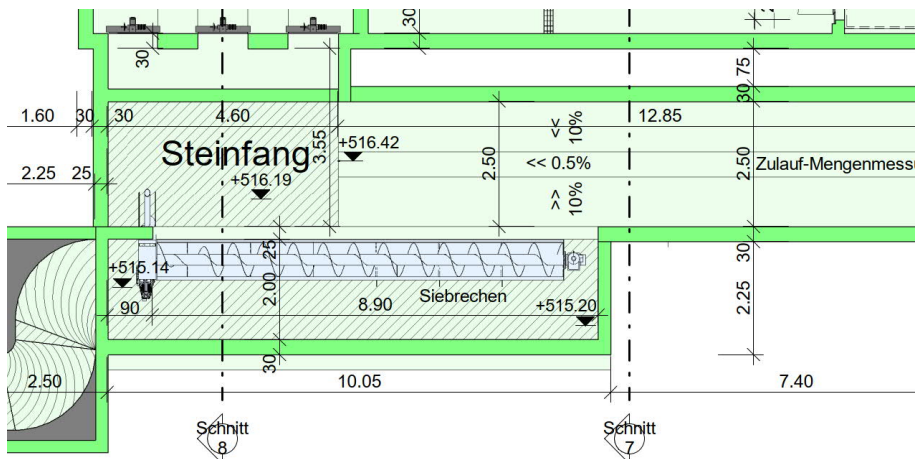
Planausschnitt; Grundriss Siebrechen
